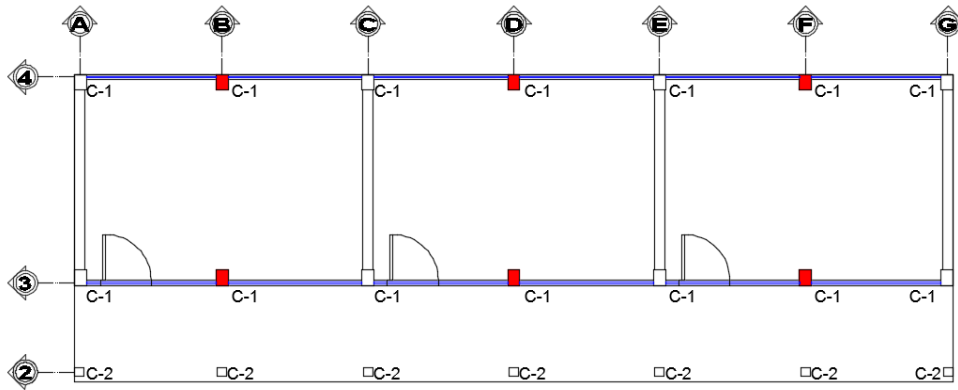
Pabellón P-3: Vista en planta de la estructura existente
